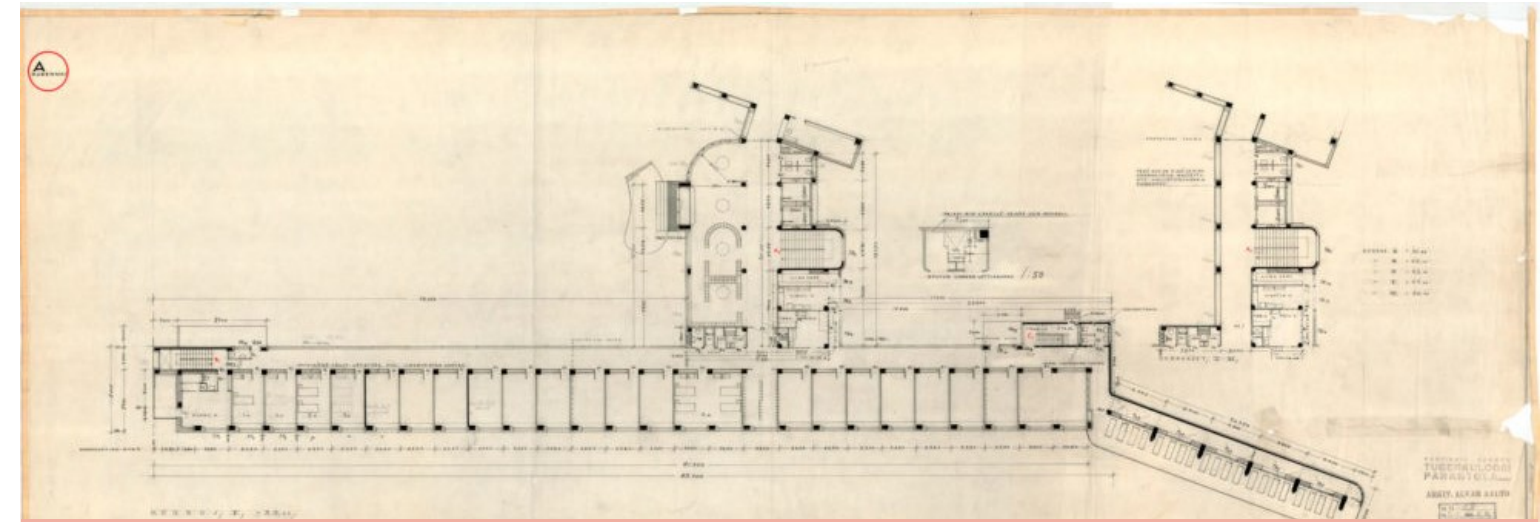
Sanatório de Paimio – Planta Baixa. Fonte: Site Alvar Aalto
